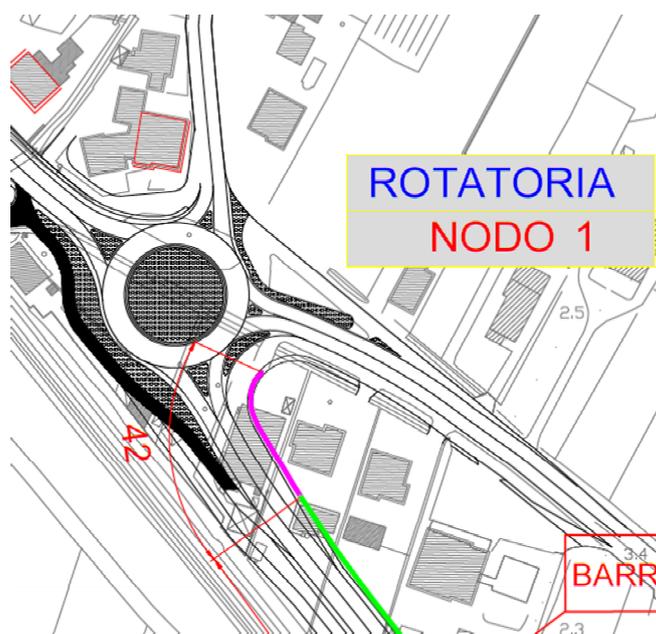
Planimetria barriere acustiche nodo 1 (lotto 1-2 stralcio)
